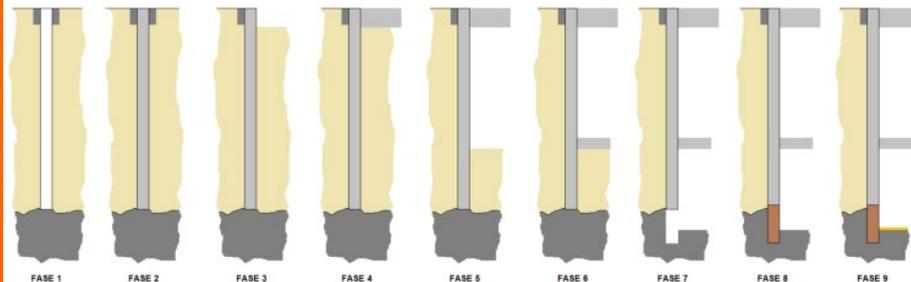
Proceso constructivo para pantallas redimensionadas en su longitud.
